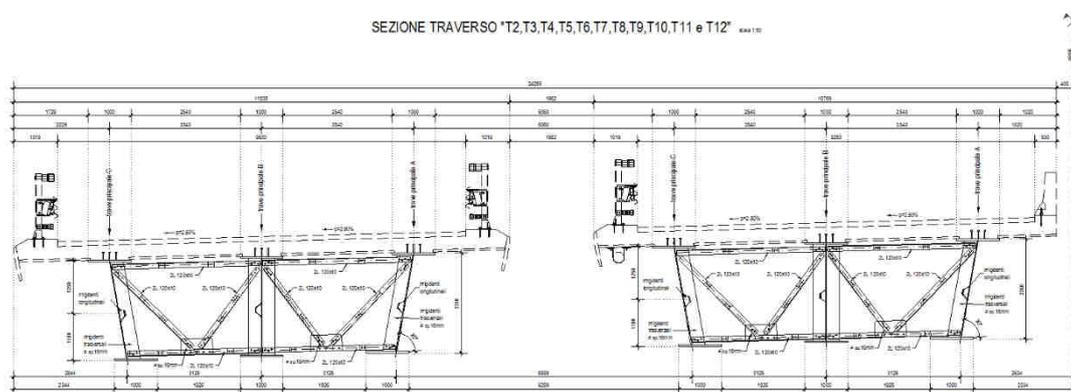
Sezione trasversale con traversi in campata – Cavalcavia svincolo SS.131dir
